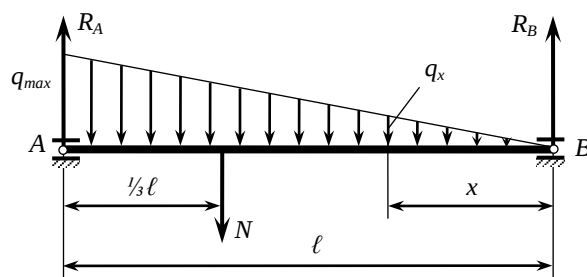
Розрахункова схема навантаженої балки з фіксованими опорами
